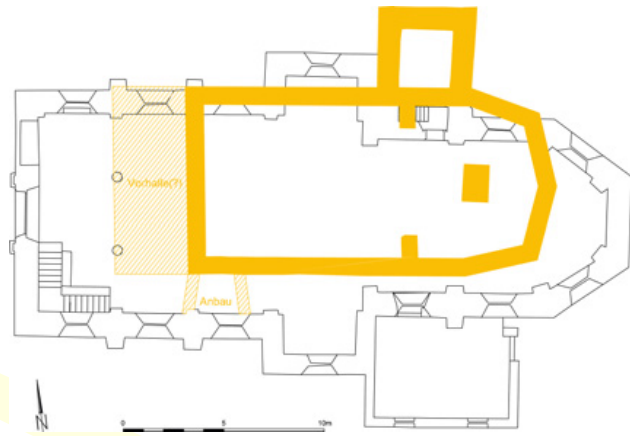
Mieming. Schematischer Grundrissplan der Kirche von 1617 mit Zubau im Südwesten und Vorhalle.
